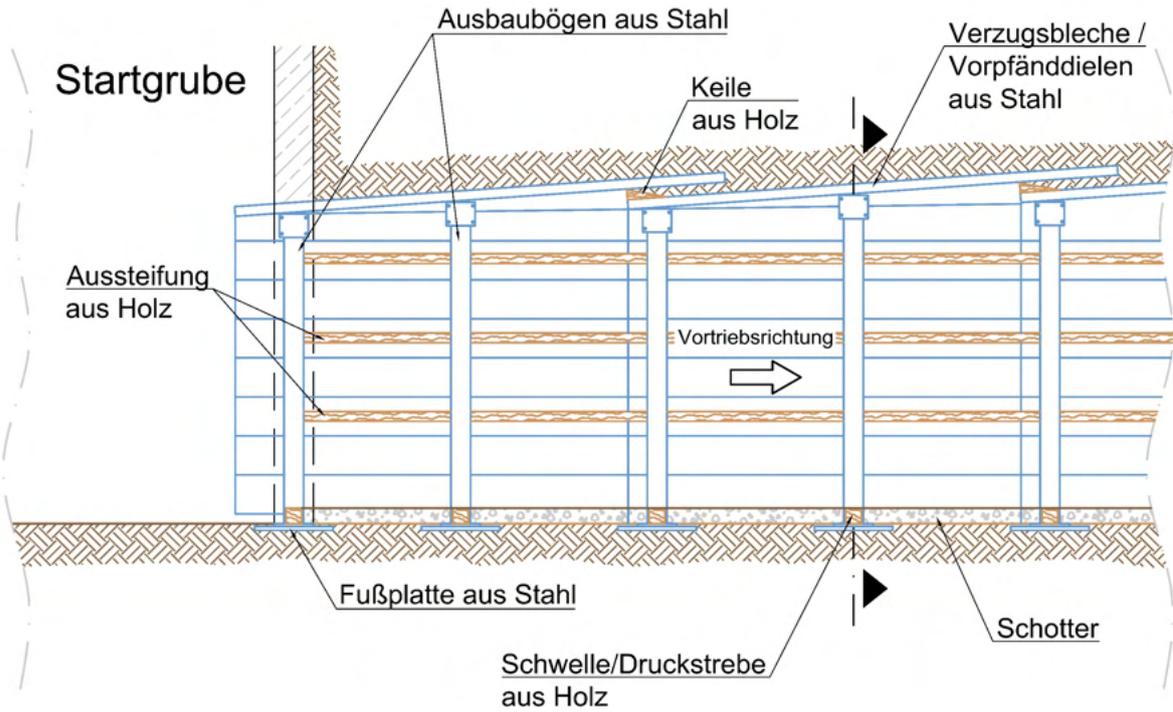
Längsschnitt Stollenbau mit Stahlverzug
